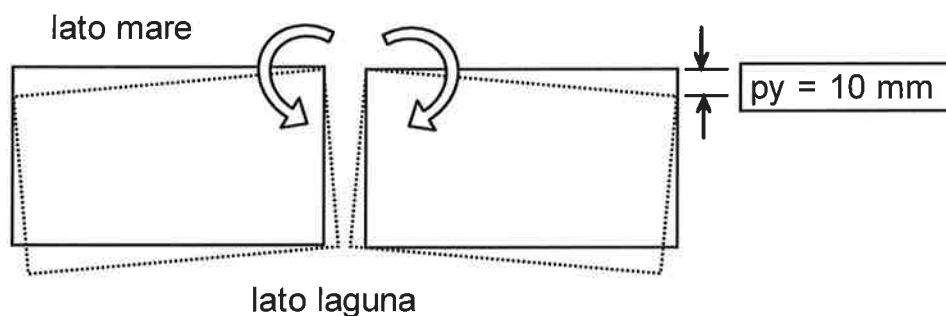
TOLLERANZA IN PIANTA (ROTAZIONE NEL PIANO) DI POSIZIONE DEL CASSONE
